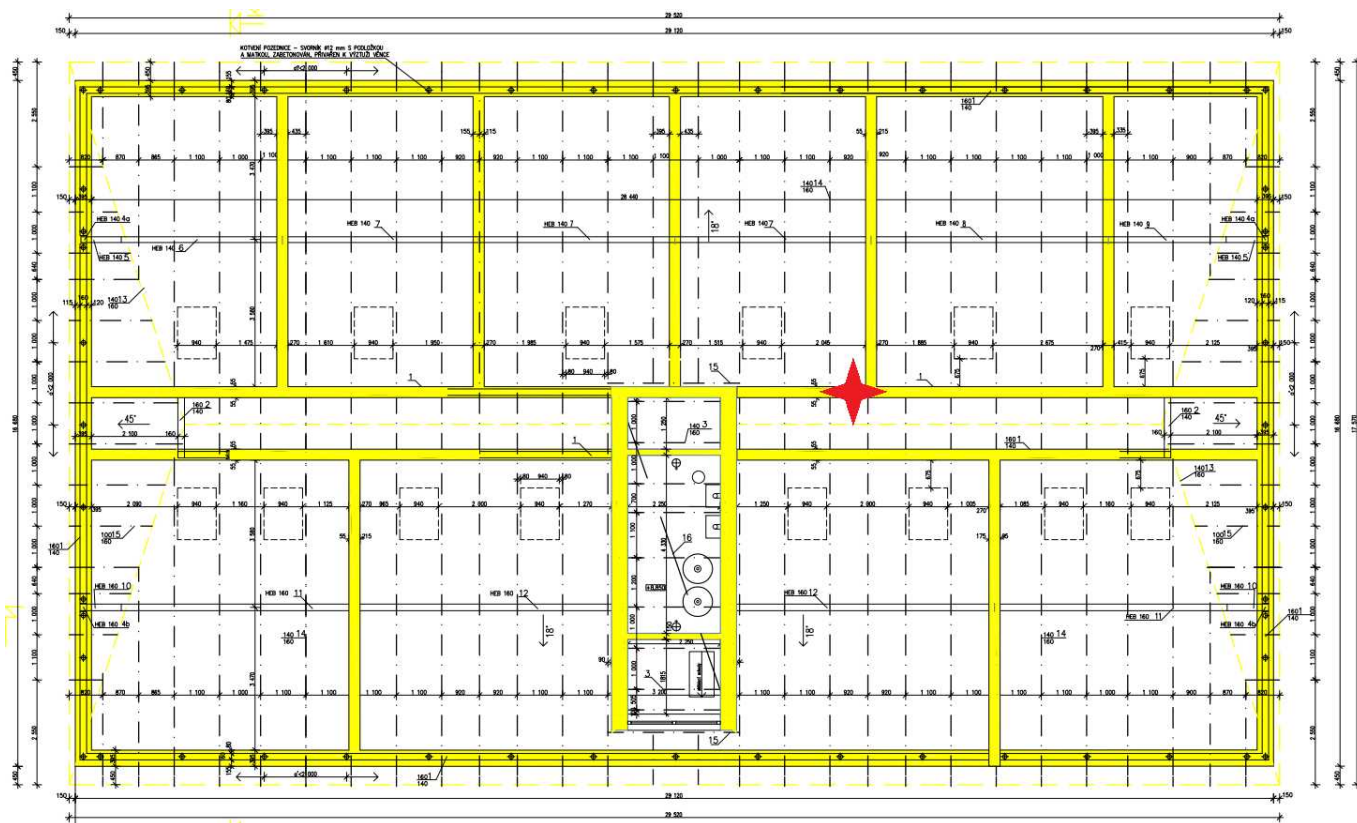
/ Poloha provedené sondy v půdorysu krovu střechy dle [9] (červeně, severní strana je nalevo)
